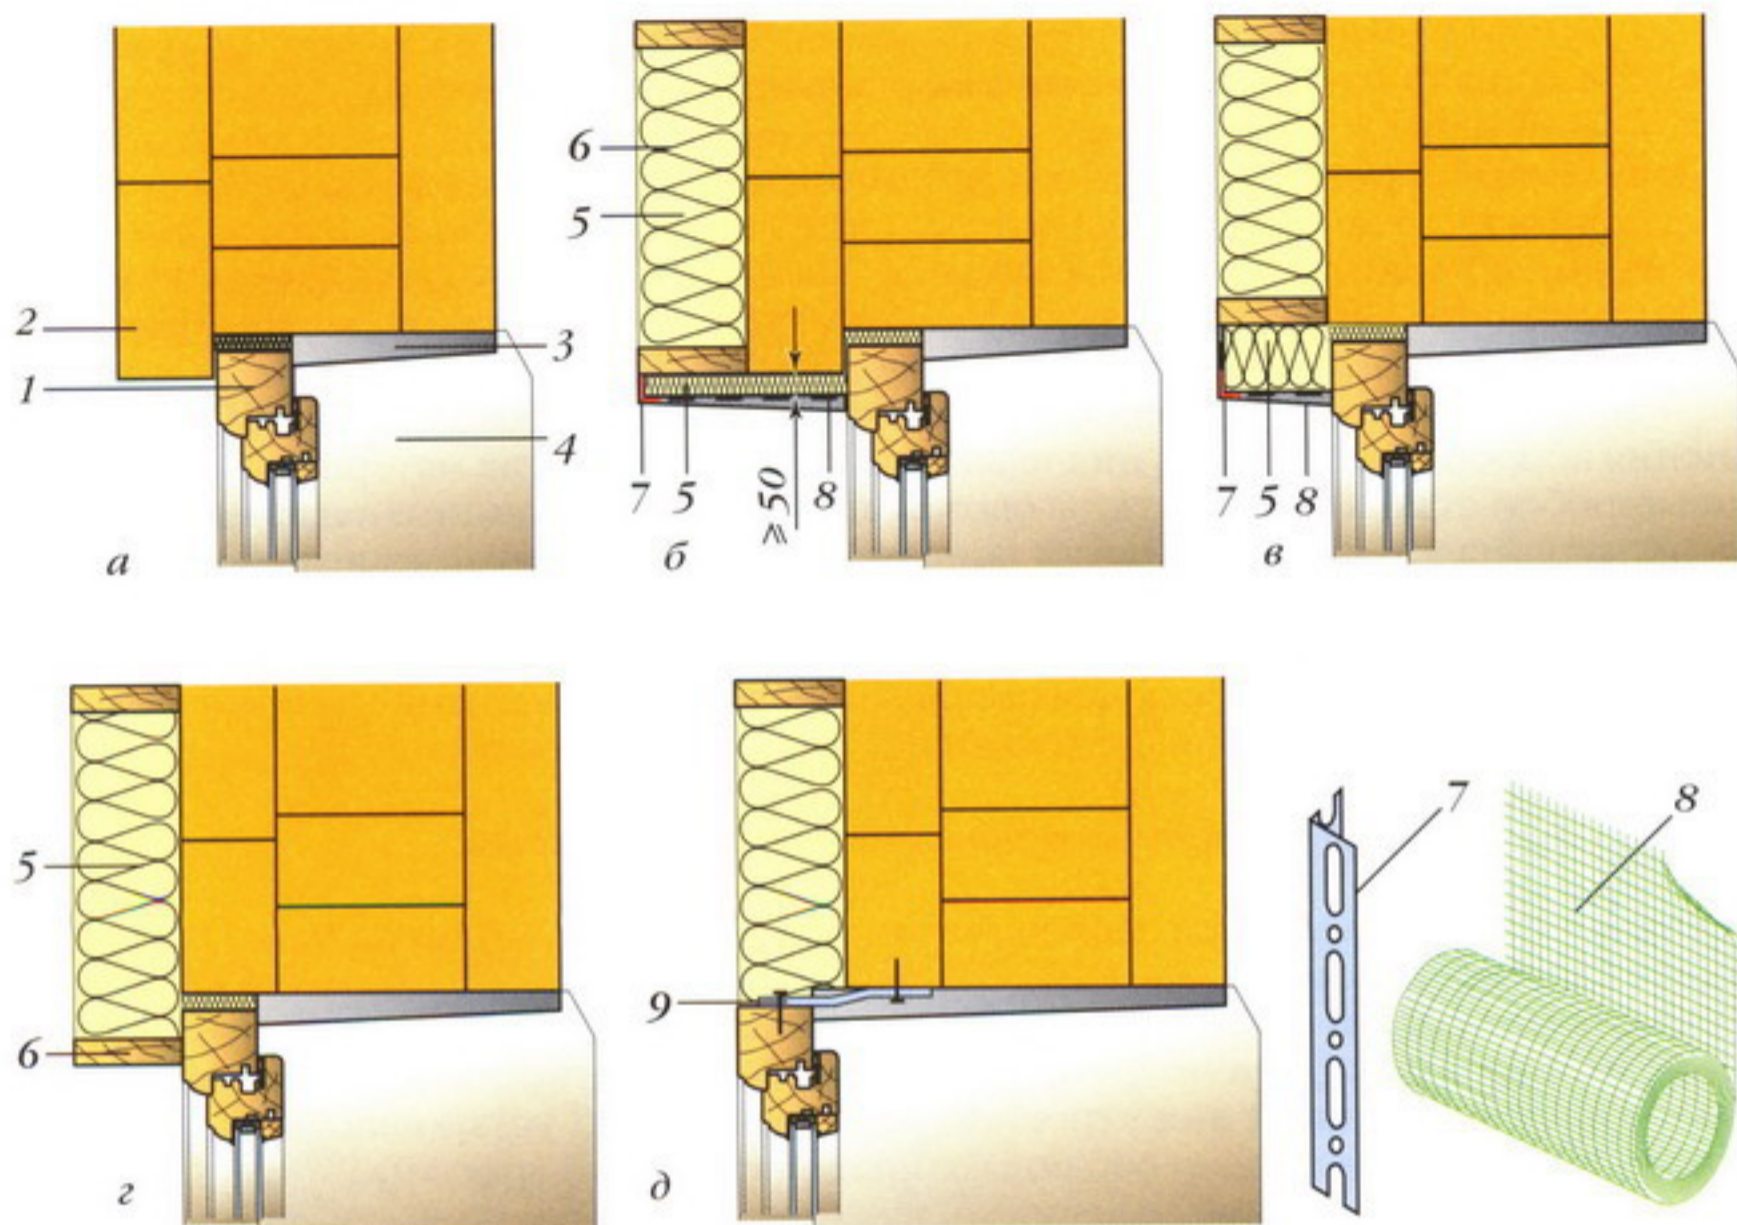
Размещение оконных и дверных проемов при утеплении стен: а — первоначальное положение окна; б — утепление окна на том же месте; в — перенос окна на место сбитой четверти; г — то же, с размещением каркаса по оконной (дверной) коробке; д — вынос окна за пределы стены; 1 — оконная (дверная) коробка; 2 — четверть в стене; 3 — штукатурка; 4 — подоконник (порог двери); 5 — утеплитель; 6 — стойка каркаса; 7 — легкий штукатурный уголок; 8 — полимерная штукатурная сетка; 9 — кронштейны
